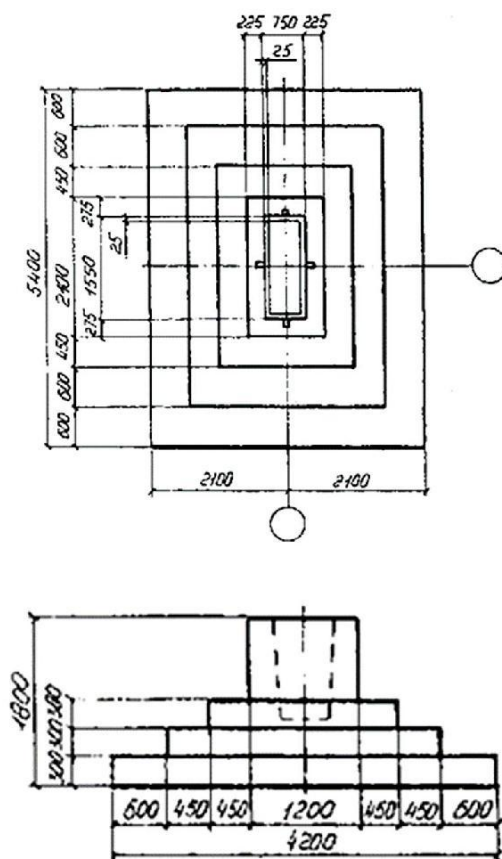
Фундамент Ф-1 под железобетонные колонны
